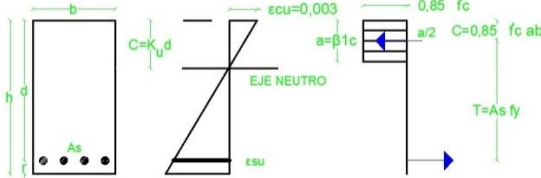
Ecuaciones para el diseño de concreto armado por la teoría de rotura. Fuente: Autor.
